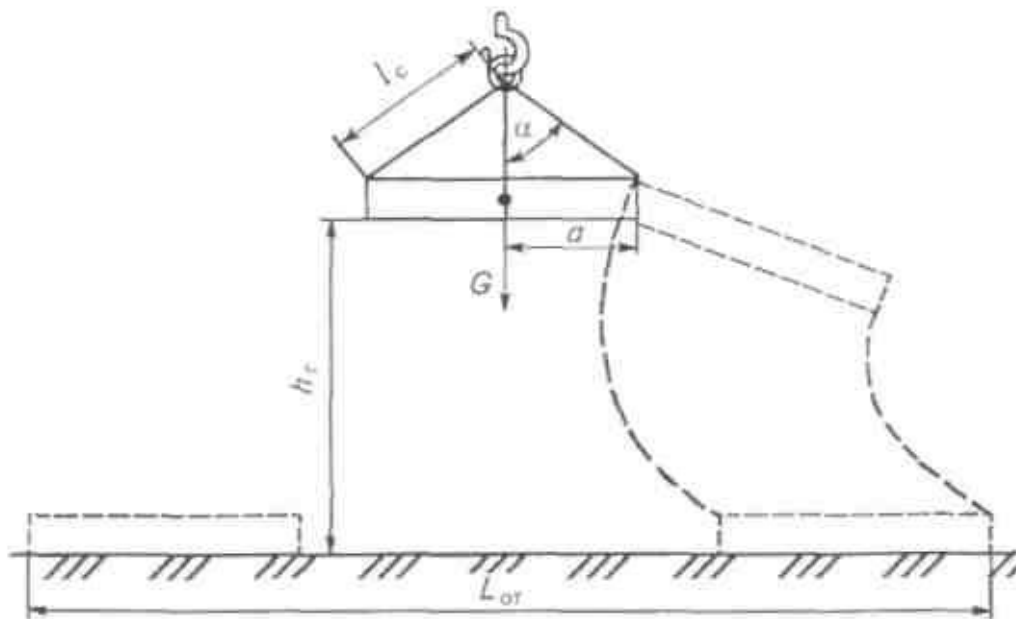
Схема определения границ опасной зоны при обрыве стропа ГПМ
